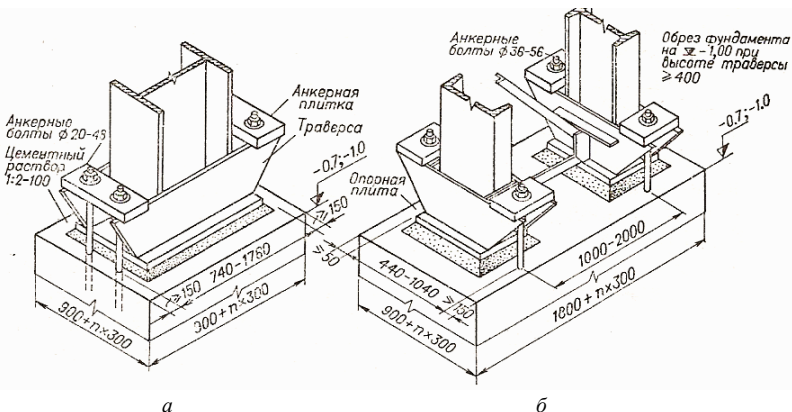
Монолитные фундаменты под стальные колонны: а – колонны постоянного сечения; б – колонны двухветвевые (сквозного сечения)
